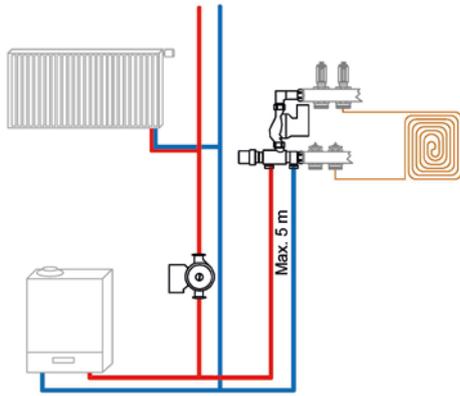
Anschlusschema mit externer primärer Umwälzpumpe
